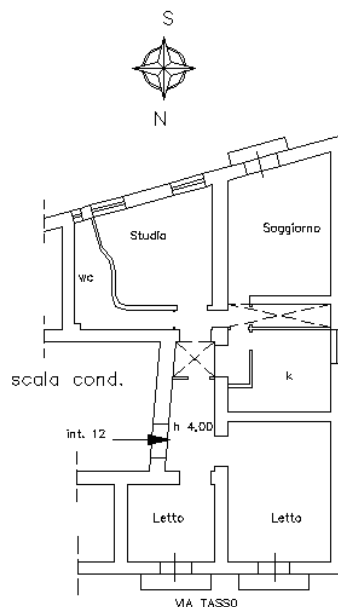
Pianta dell'immobile oggetto di riqualificazione energetica
